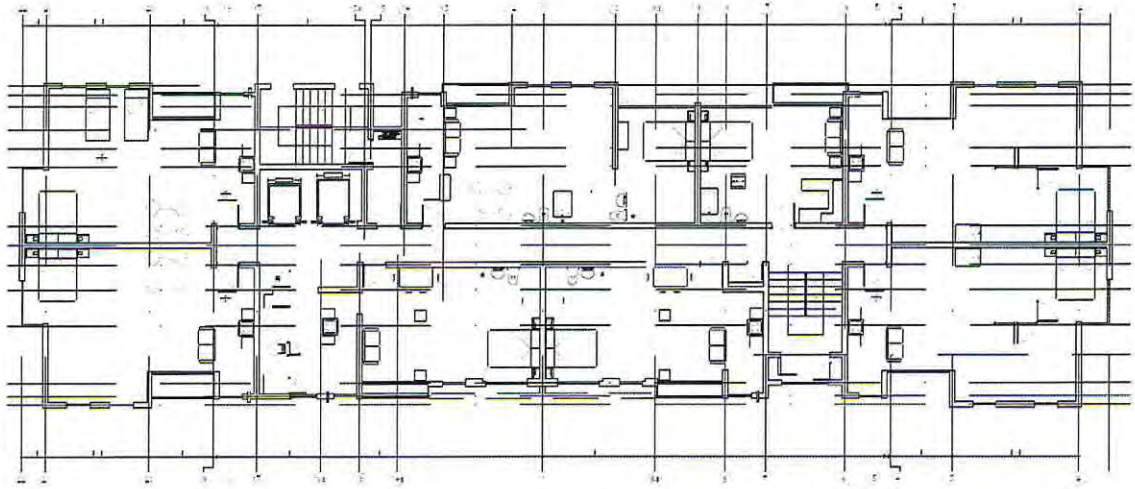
Planta esquemática edificio Habana (Recreo).
